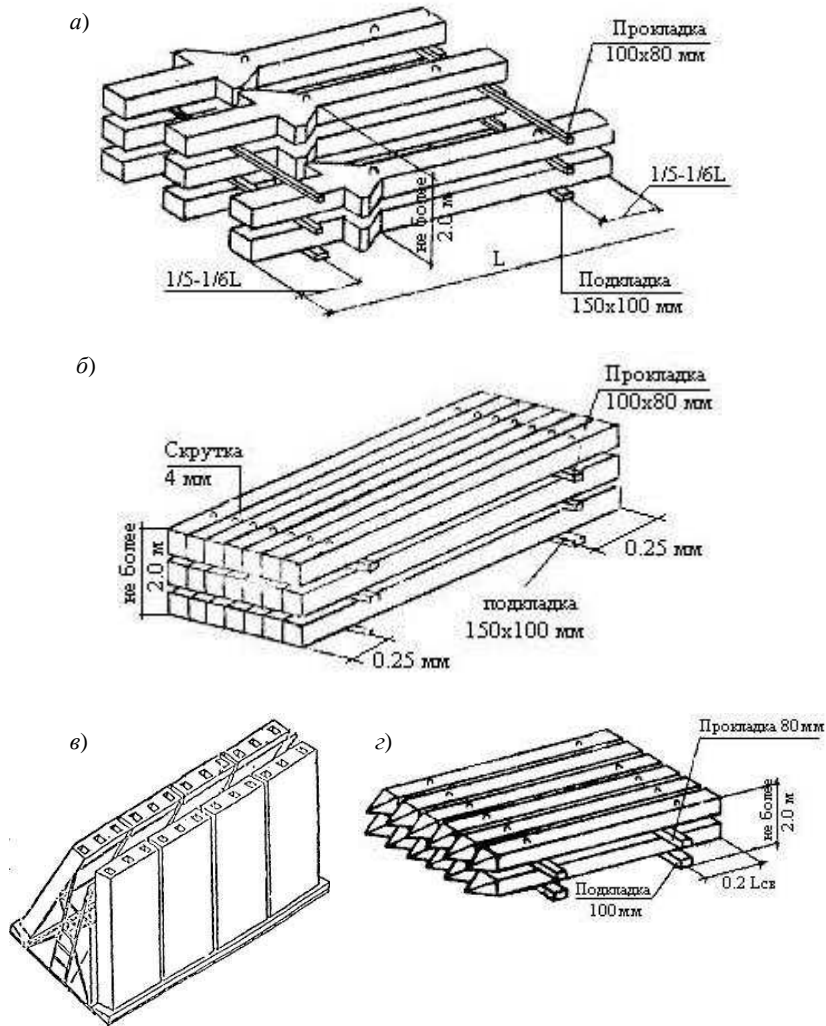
(начало) – Схемы размещения на складе железобетонных изделий
